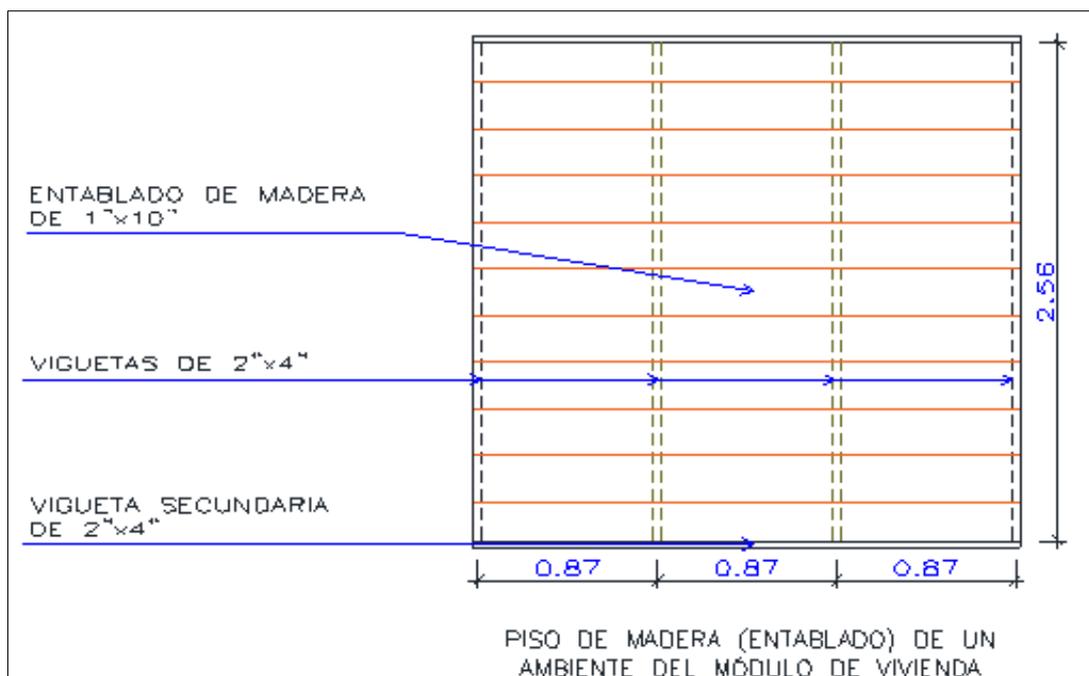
Entablado de madera de un ambiente del módulo de vivienda
